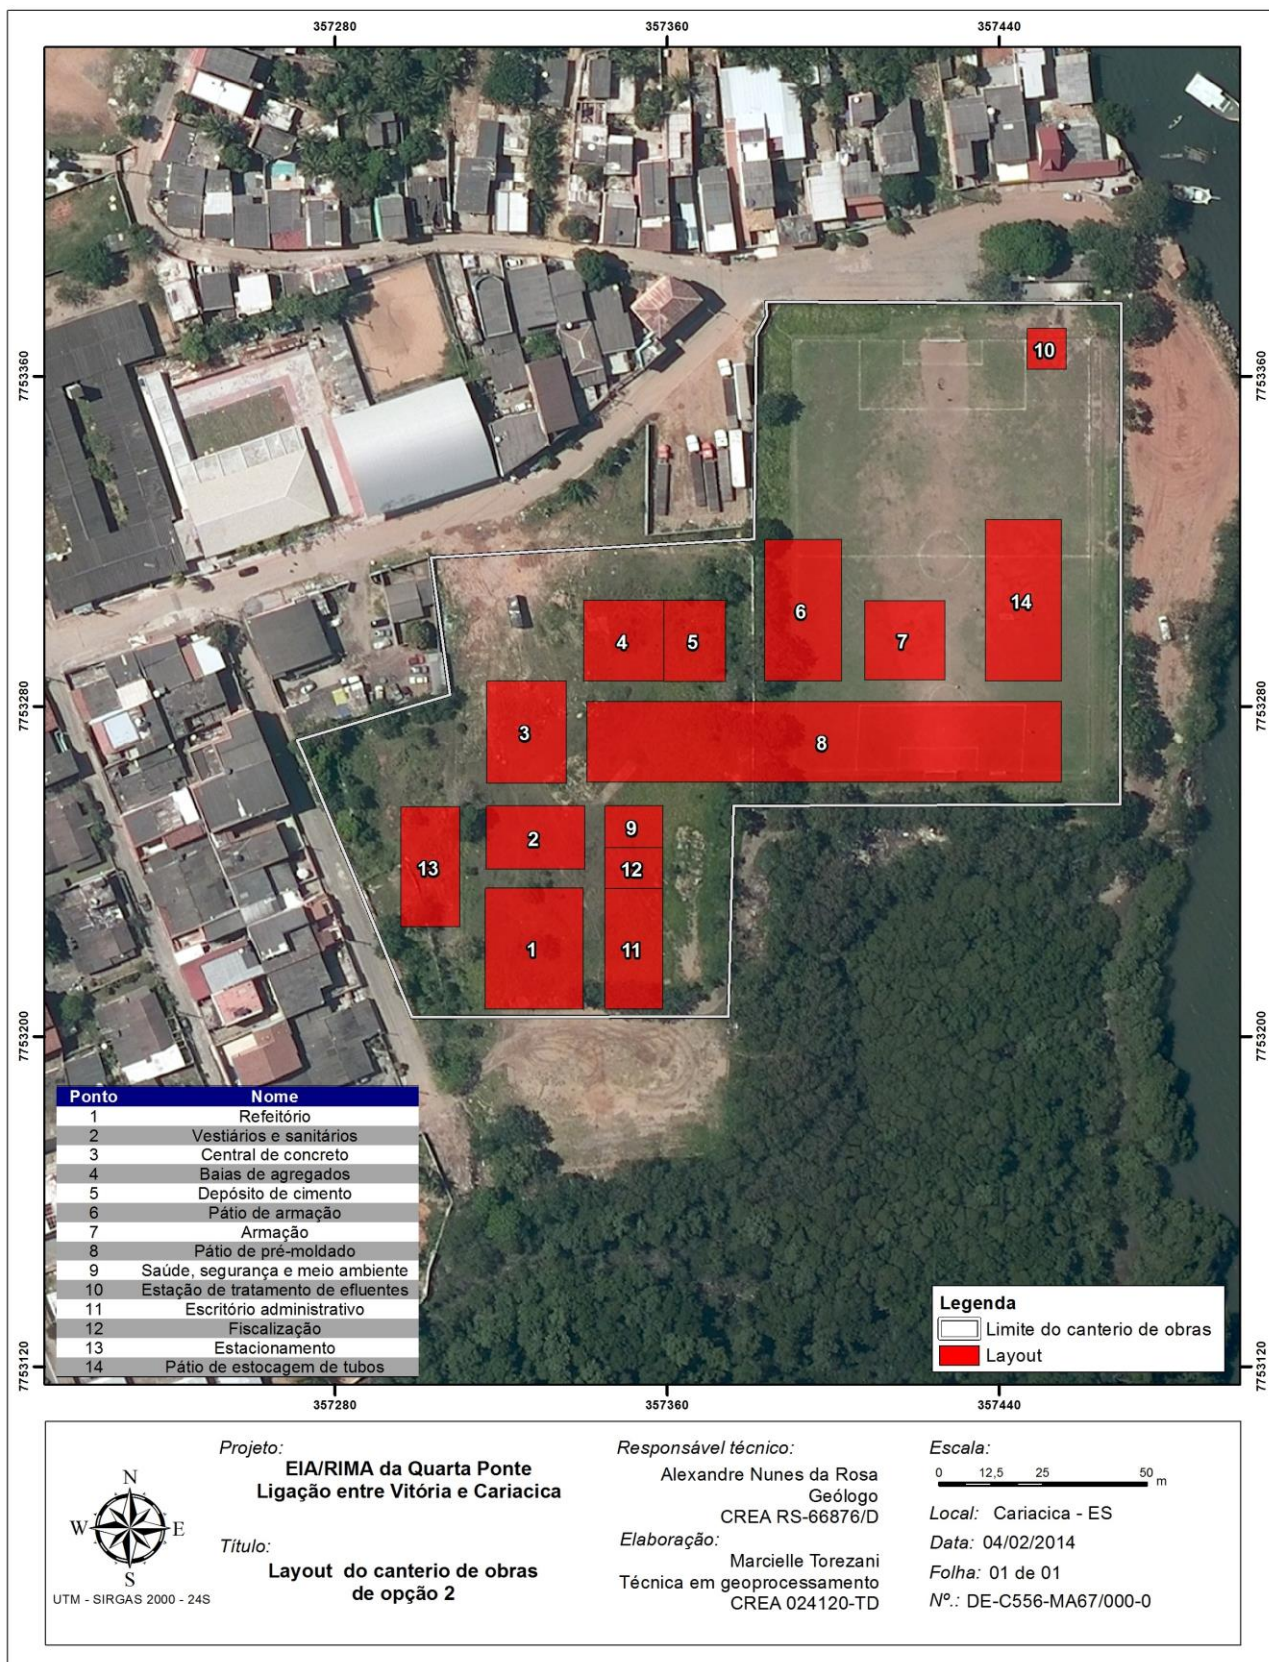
Layout da Opção 2 do canteiro de obras.
